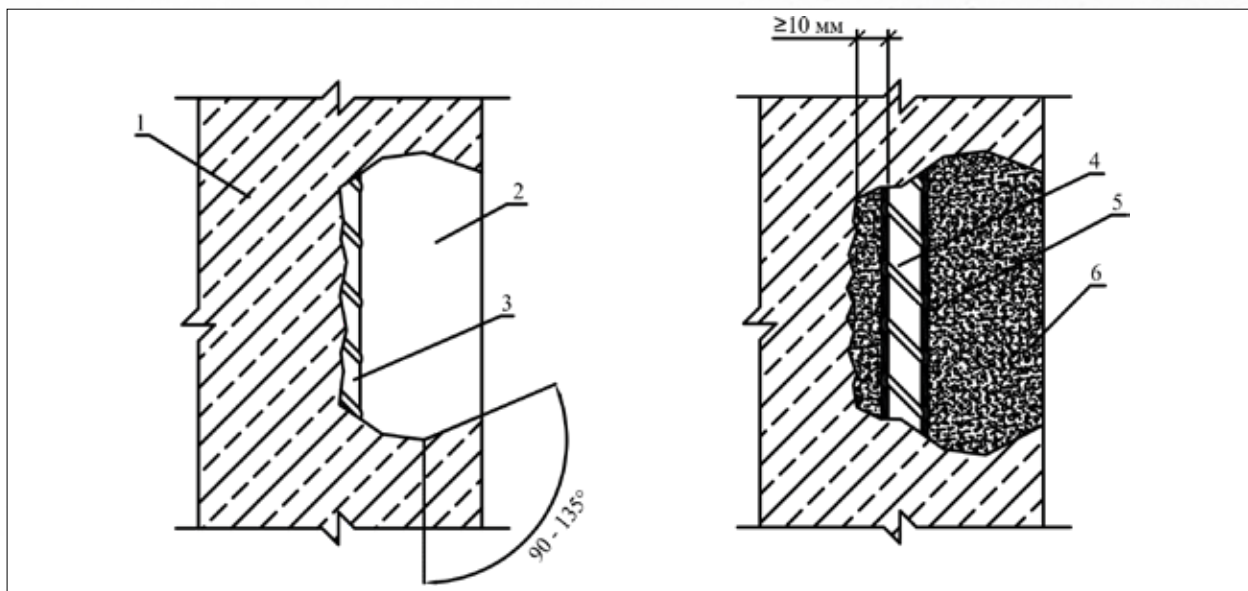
Схема восстановления защитного слоя бетона: 1 – железобетонная конструкция; 2 – участок с поврежденным защитным слоем; 3 – оголенная арматура; 4 – раствор «Скрепа М500 Ремонтная»; 5 – очищенная арматура; 6 – защита арматуры от коррозии раствором «Скрепа М600 Инъекционная»
